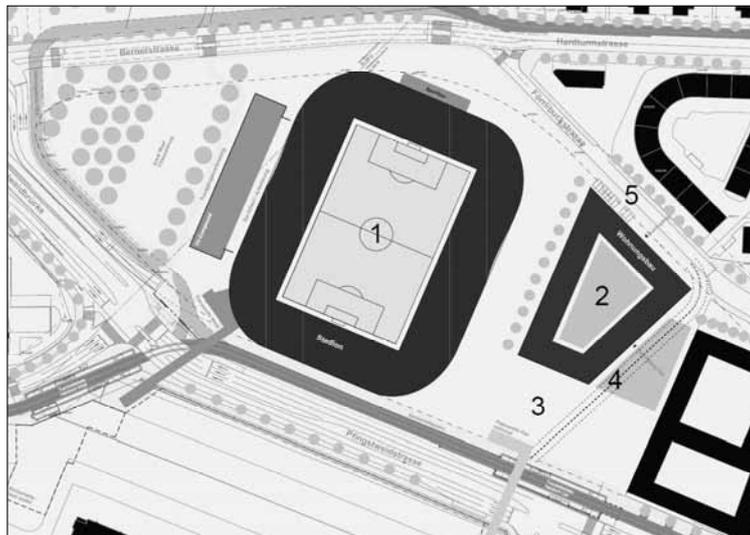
Dachaufsicht Stadion und Wohnbau
